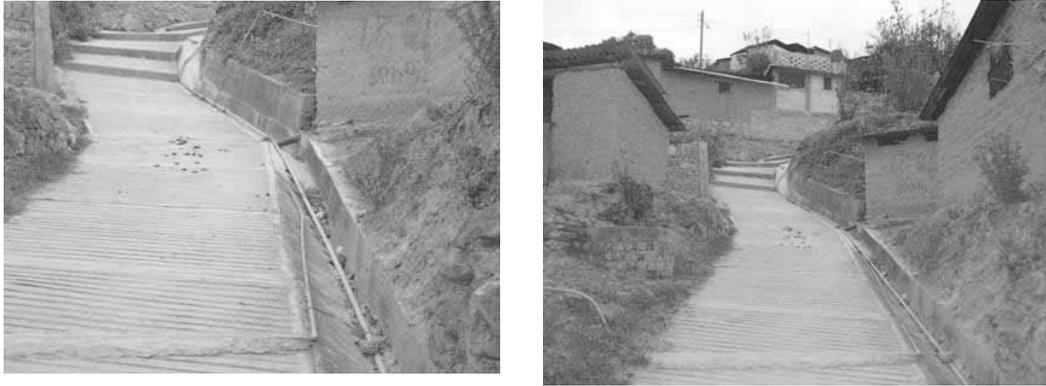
Pavimentación de las calles y sistema de agua potable
